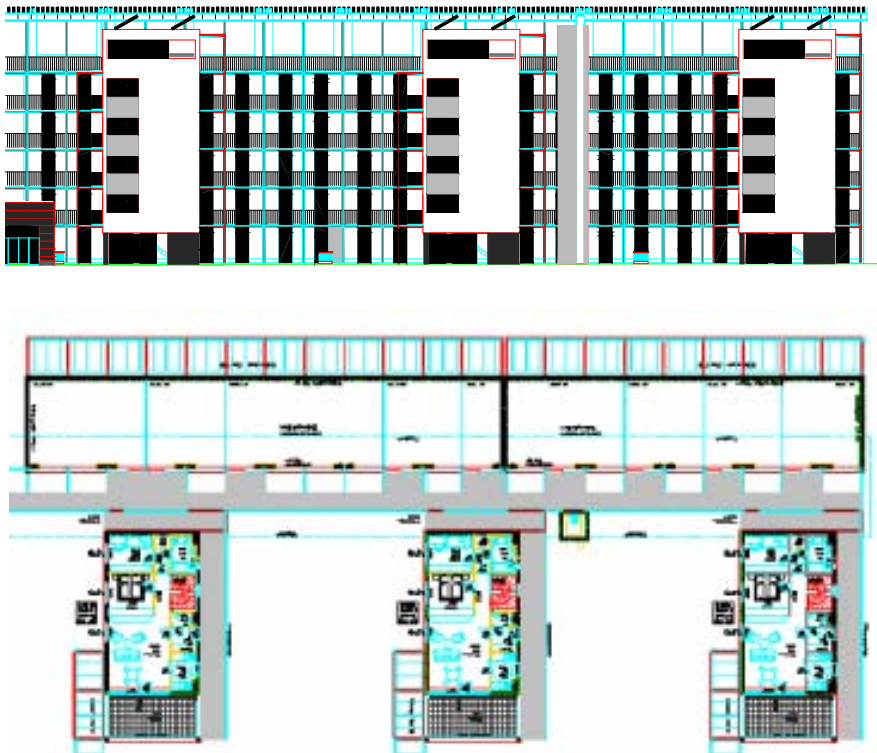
Ostansicht und Grundriss des Demonstrationsobjektes „Sandgasse“ (Bildquelle: Architekt Tschom)
